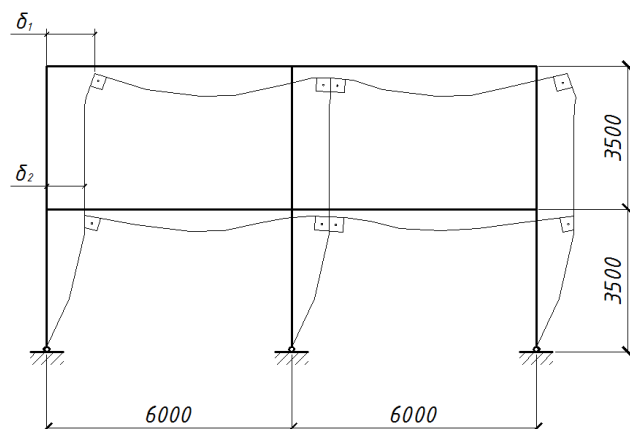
Деформированное состояние рамы (с шарнирным соединением колонны с фундаментом)
